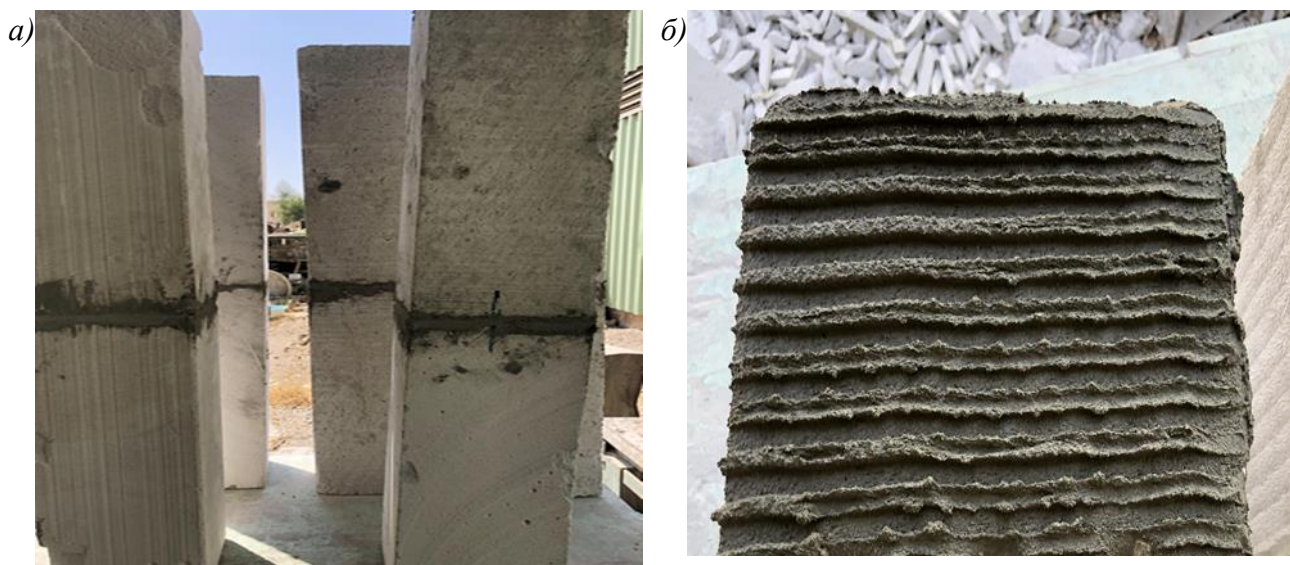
Подготовка составных перемычек: *а* – склеивание газобетонных перемычек и их вертикальная установка; *б* – нанесение раствора
